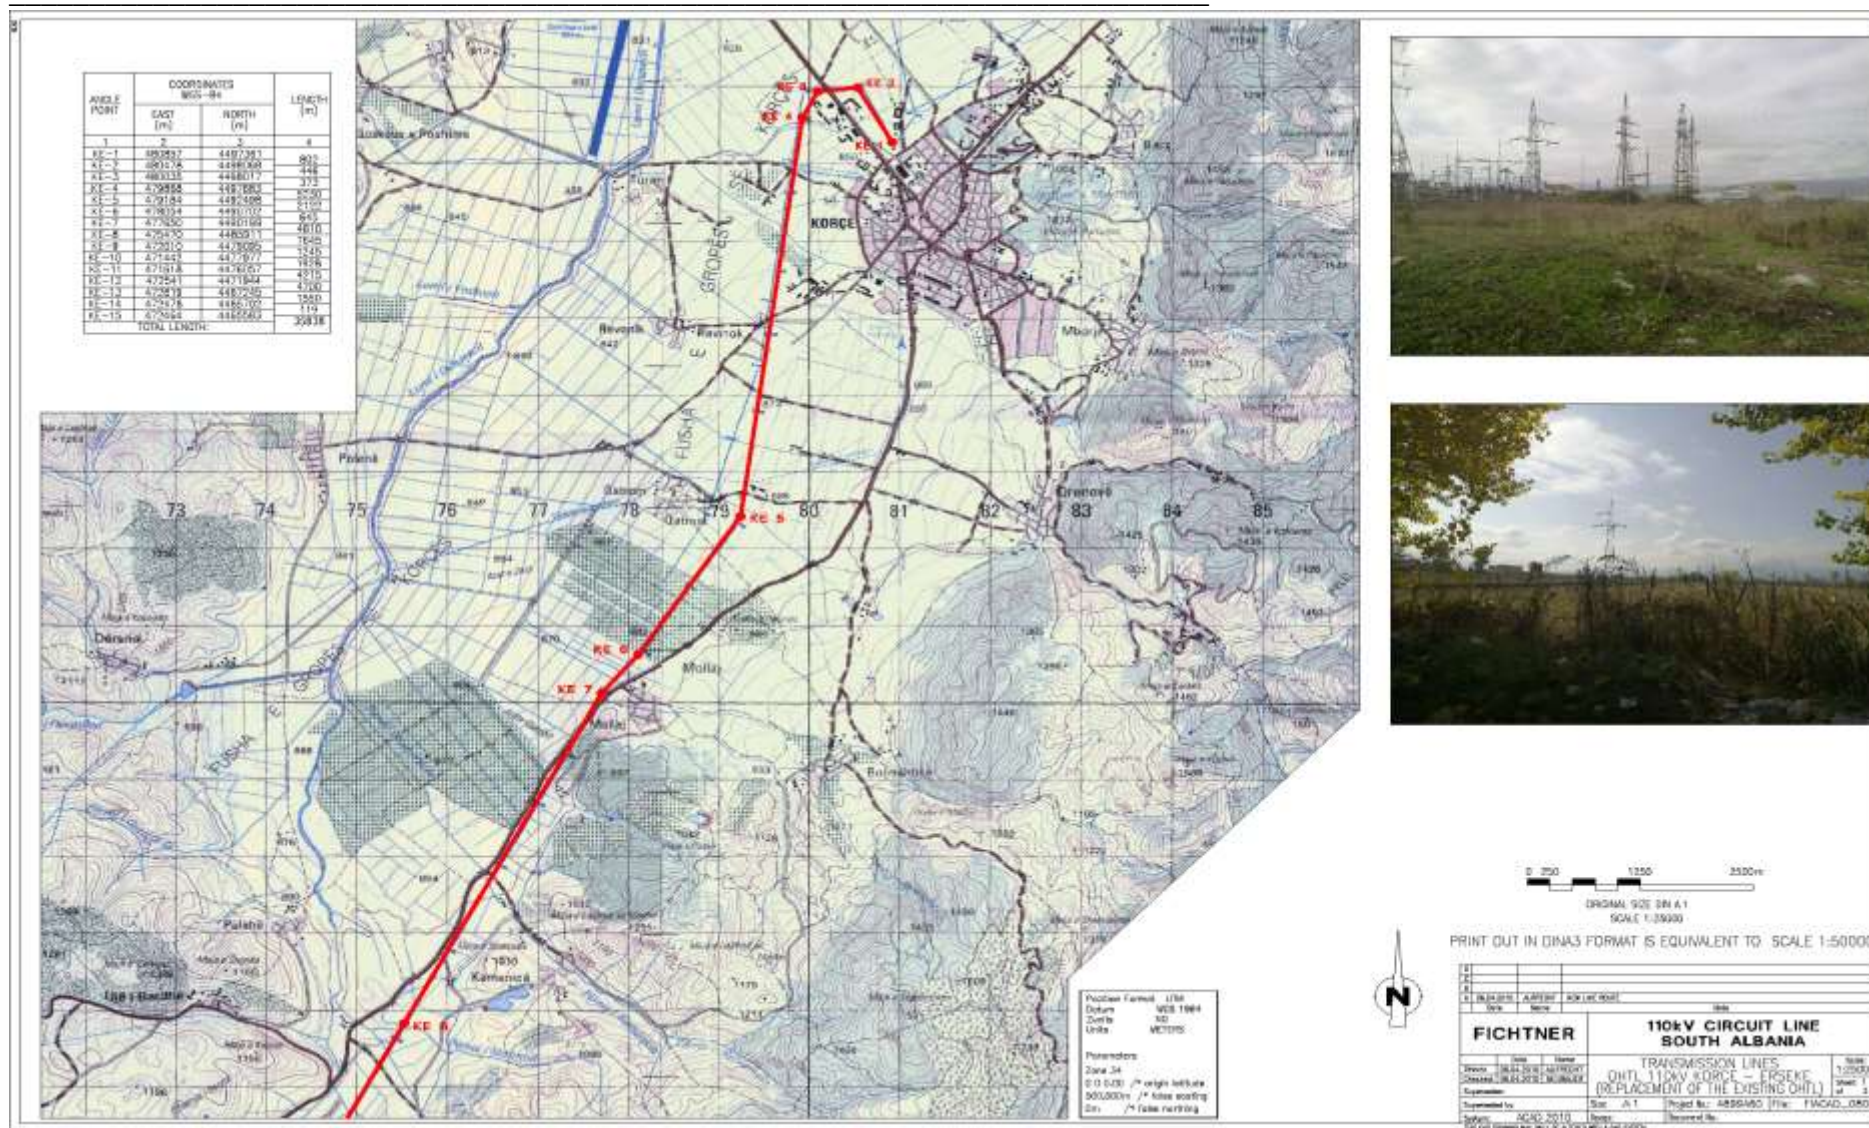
/8.: Planimetria e vendosjes se linjes 110 kV Erseke-Korce (harta trete)
